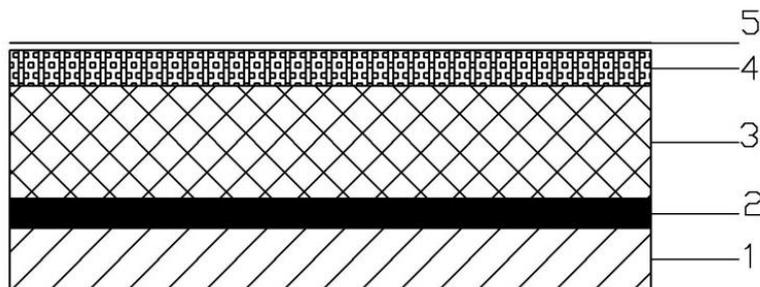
Схема устройства засыпной теплоизоляции:
